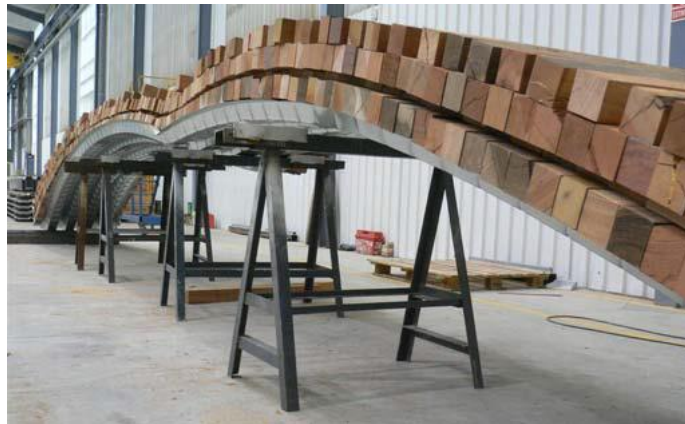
Ensayo de características eficaces de los perfiles carga distribuida uniformemente
